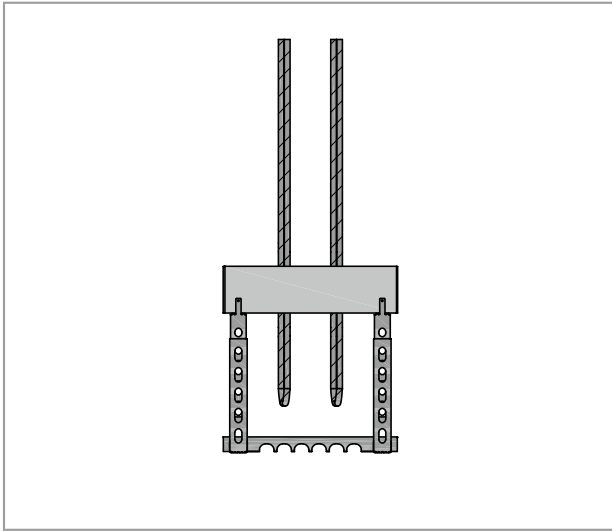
Schöck Sconnex® type W: Product view with installation aid
